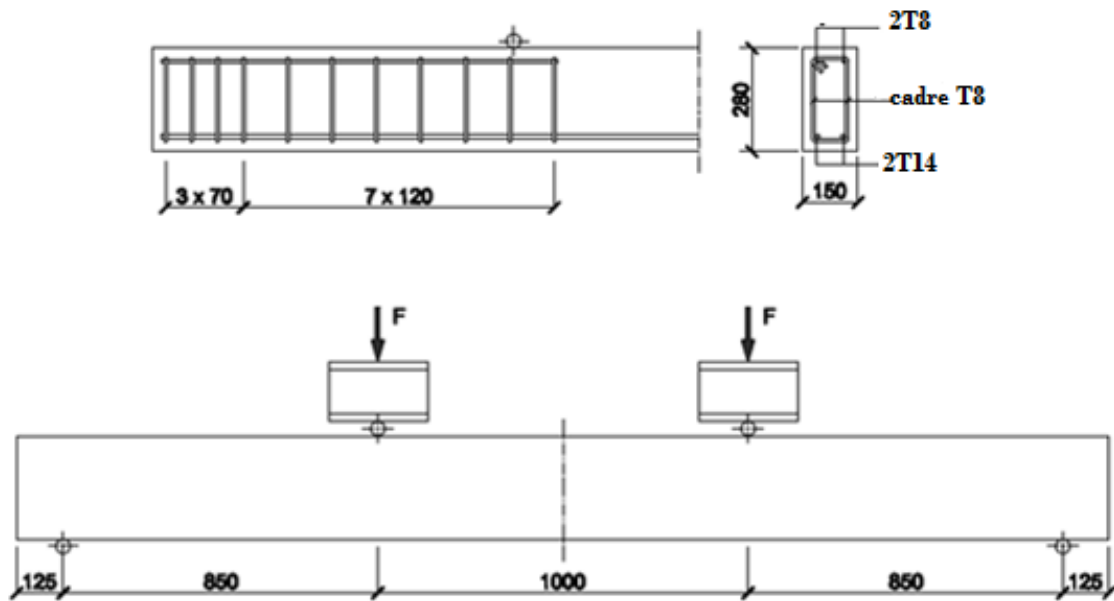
Rappel de la géométrie et du ferrailage des poutres testées
